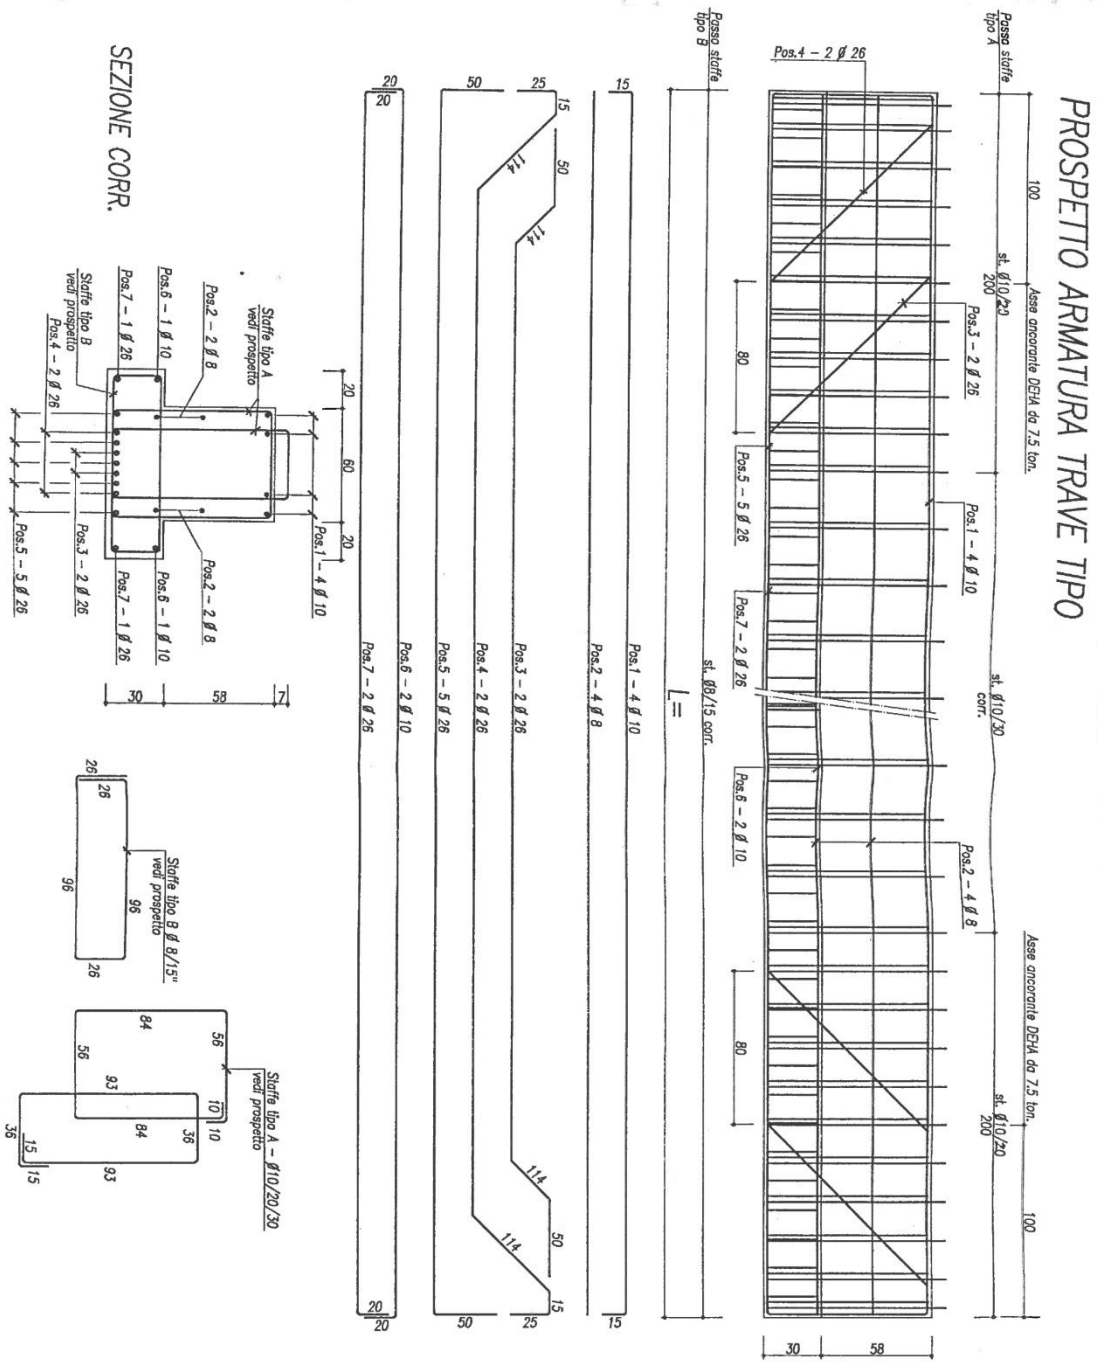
Particolare di A.1996.cap.sa.T07 - Armatura e abaco travi rettangolari 60 x 40 (piano primo) - Armatura travi tipo B-B1-B3
